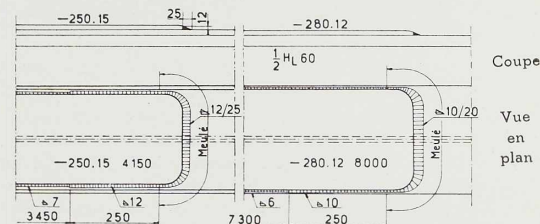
Détail de la soudure des extrémités des semelles placées au droit des palées. Ces semelles ont été soigneusement raccordées à la membrure des poutres principales.
